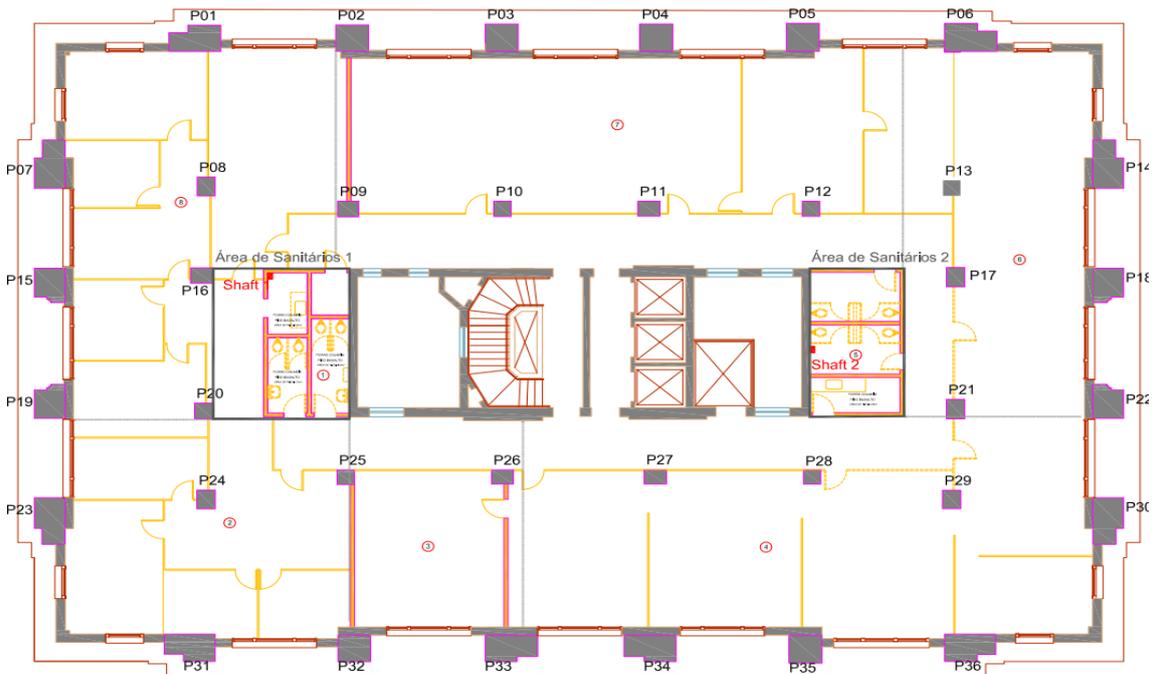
Planta 1º pavimento com 837,36m<sup>2</sup>
